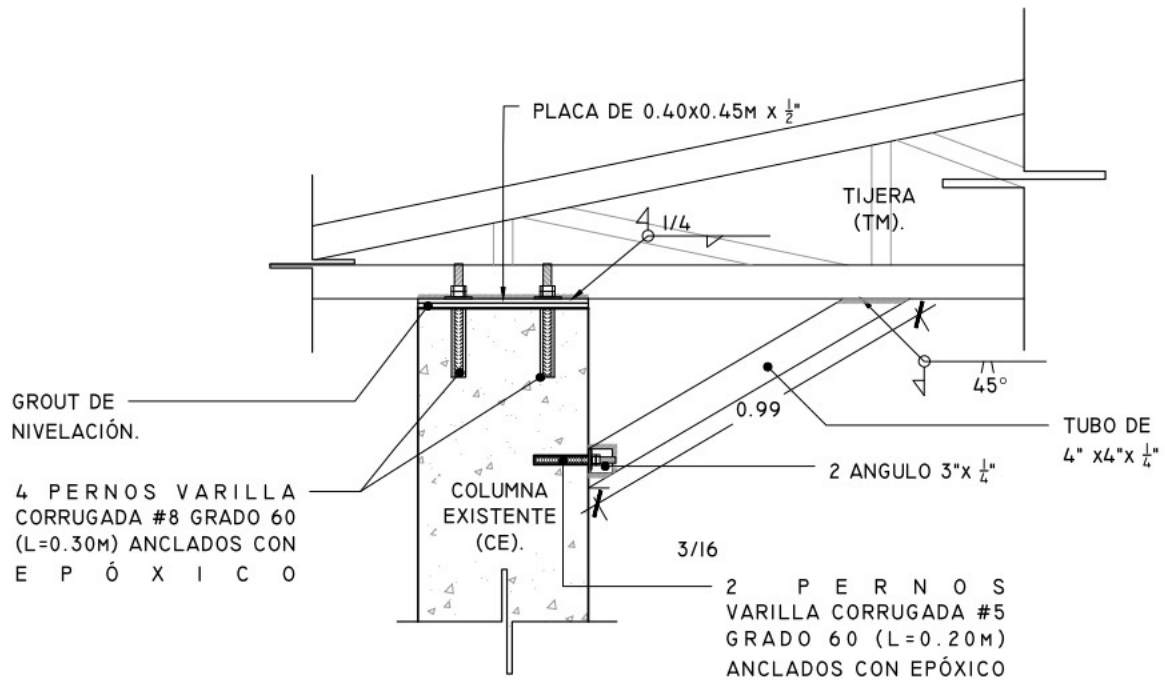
Columna de concreto existente dónde se apoya la estructura de techo. Fuente: Elaboración Propia.
